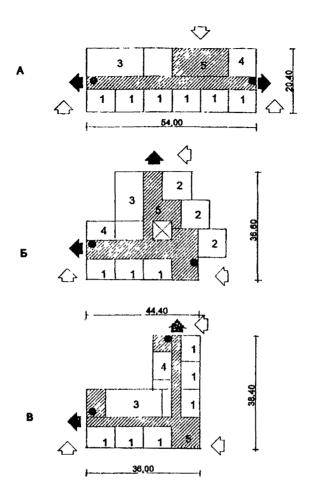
Варианты планировочных схем блоков-пристроек начальной школы на 8 или 12 классов
